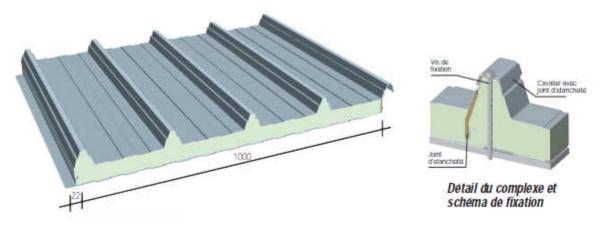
Panneau sandwich voir la fiche technique (annexe 01).
